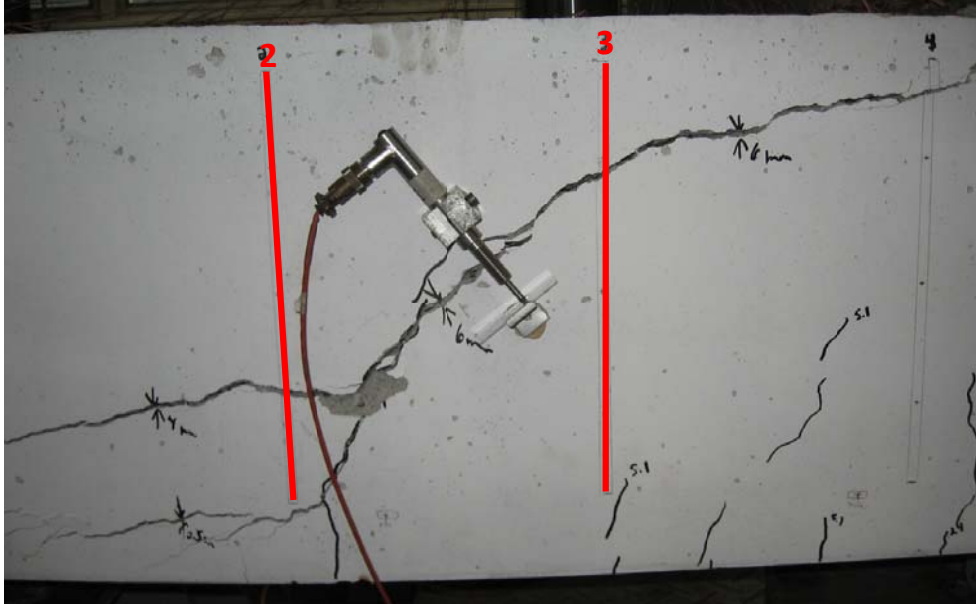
Position des barres de renforcement #2 et 3 de la dalle 2ba, face sud
